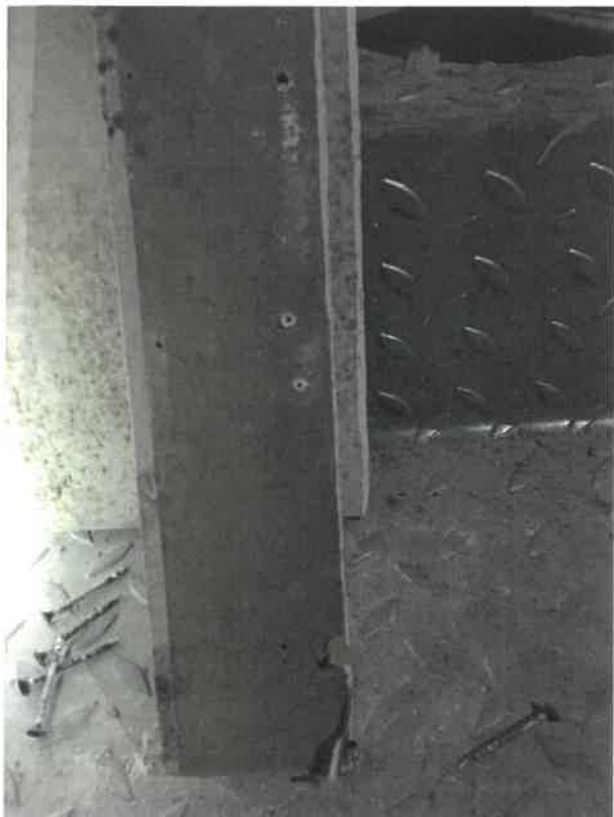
2.9. Åbning ved dør. Bagside af bageste gipskarton mod trapperum.
